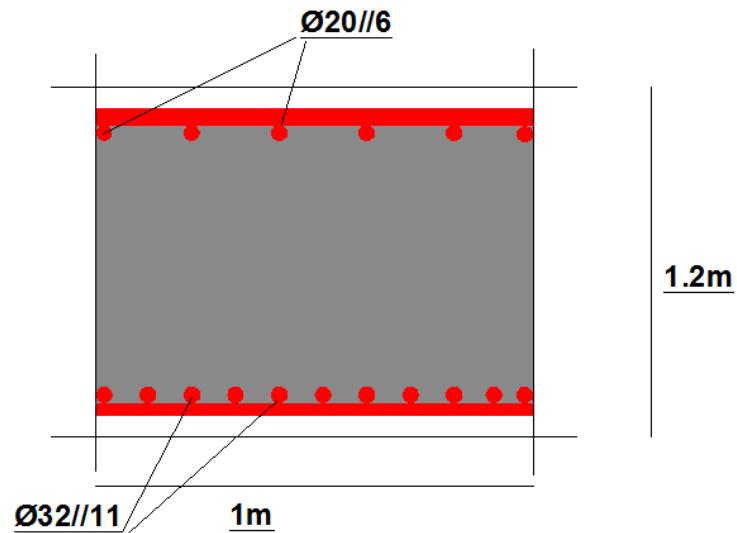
Schéma de ferrailage à mis travée dans la direction transversale (Coupe A-A)
